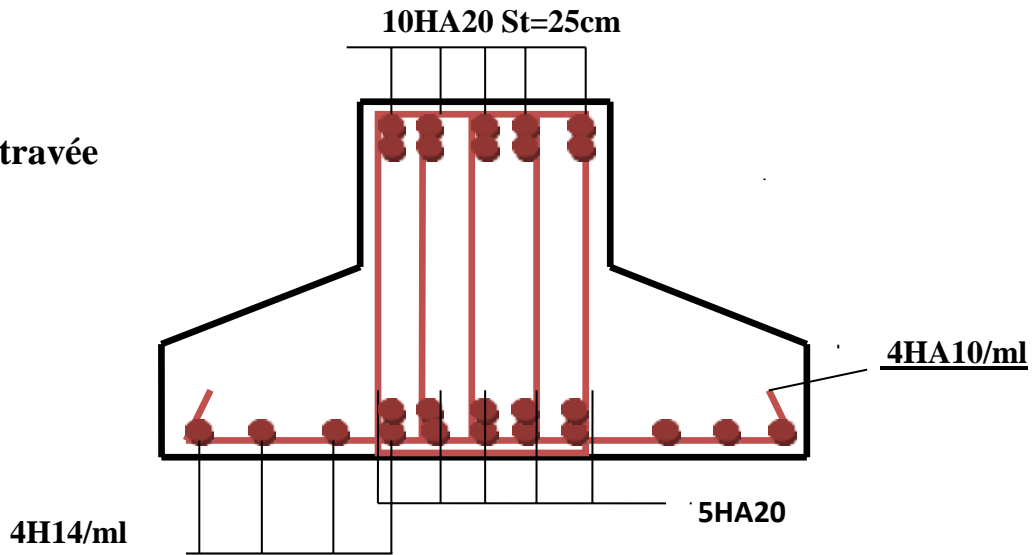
Schéma de ferrailage de la semelle filante (coupe B-B)
